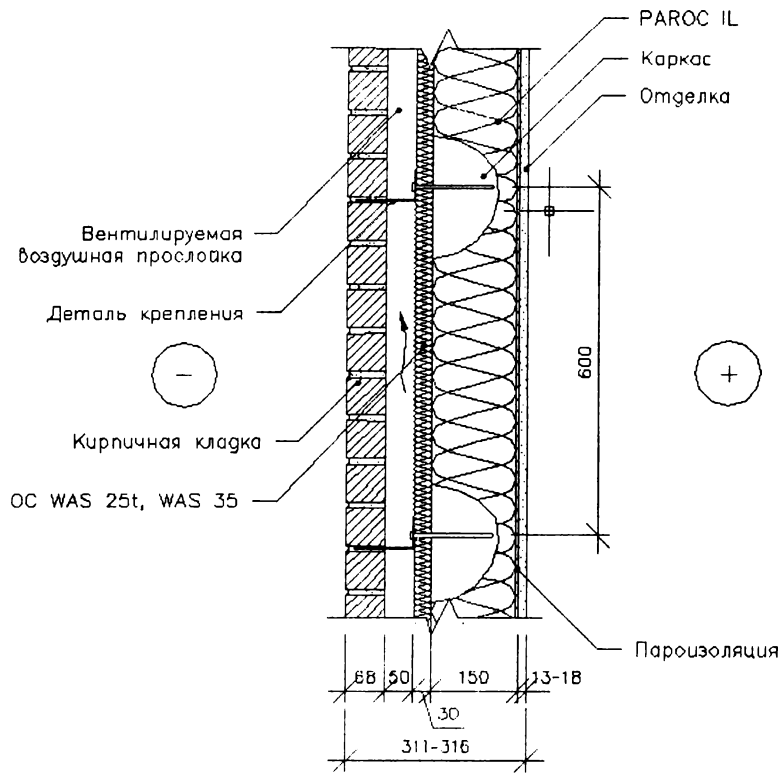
Обмурованная стена деревянного каркаса с применением ветроизоляционной плиты WAS 25t, WAS 35
